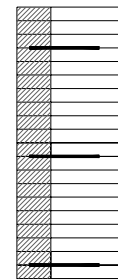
Sección de muro doblado de 1,5 pies con anclajes.
